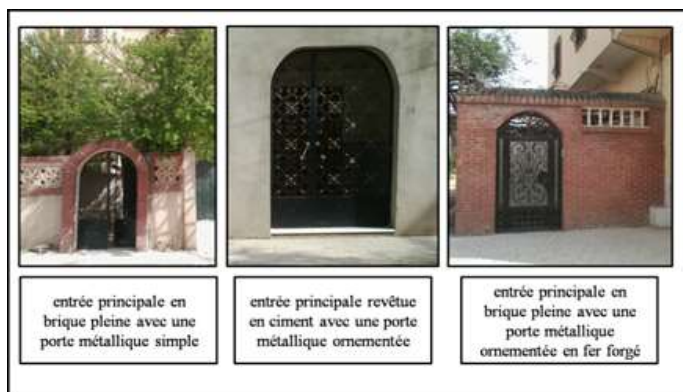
,12 : Images de maisons présentant le contraste entre les façades
